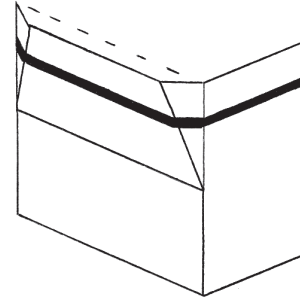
Schéma : déconnexion entre la toiture et un mur extérieur.
